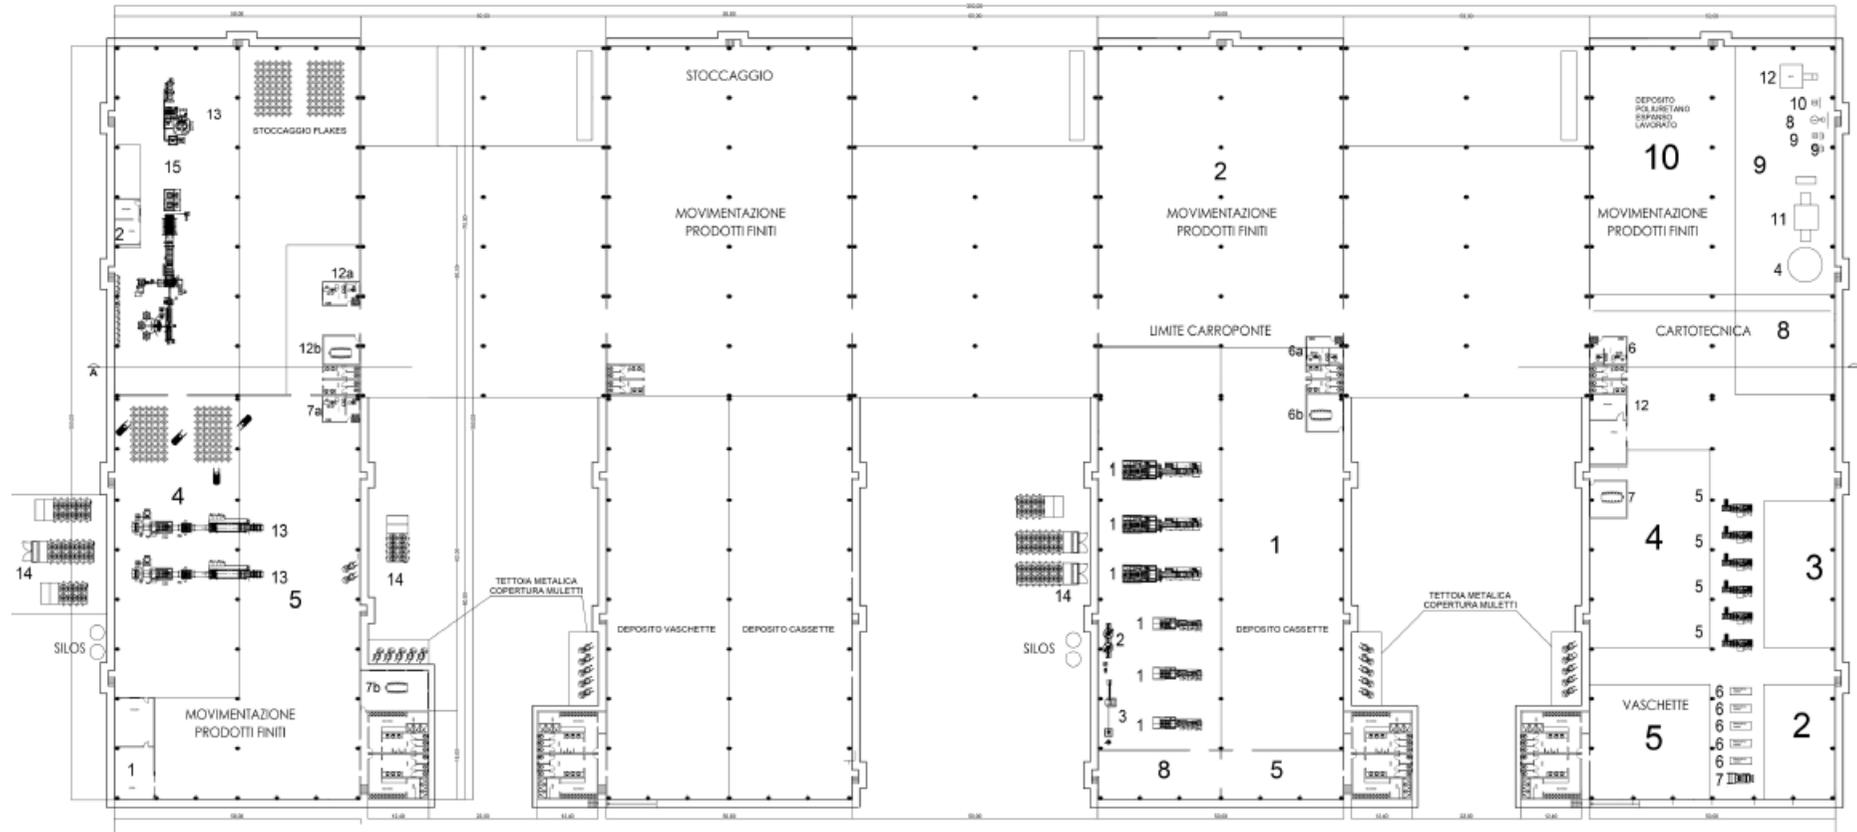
Stralcio layout di progetto: nuovo edificio
